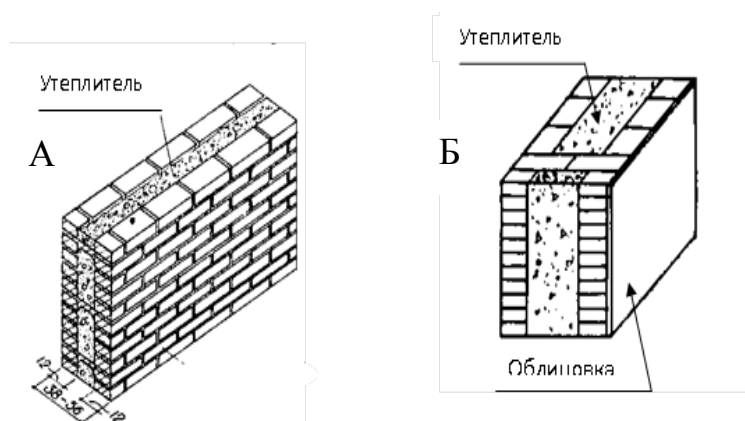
Примеры кирпичных стеновых блоков. А- сплошная кладка; Б – блок с утеплителем, облицованный сухой штукатуркой.
